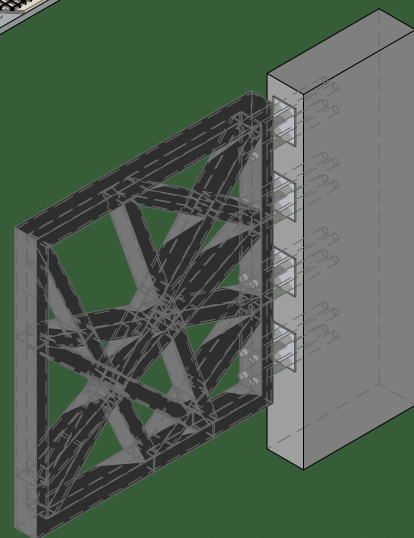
Detalhe encaixe treliça e pilar com parafuso estrutural
